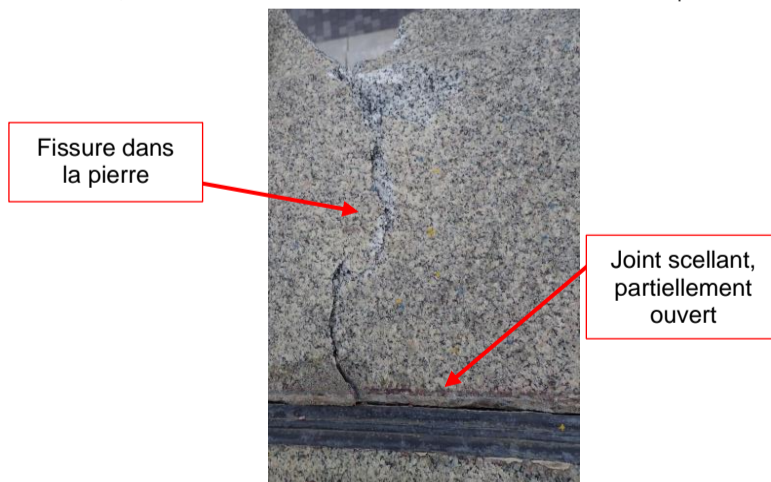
fissure et joint scellant de plomb, partiellement ouvert
